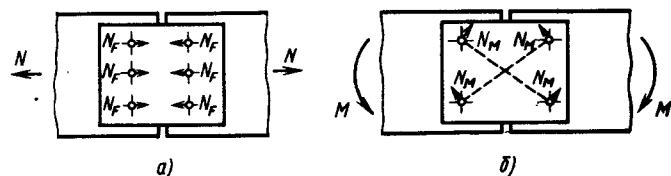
Схемы к расчету болтовых соединений, работающих на сдвиг
